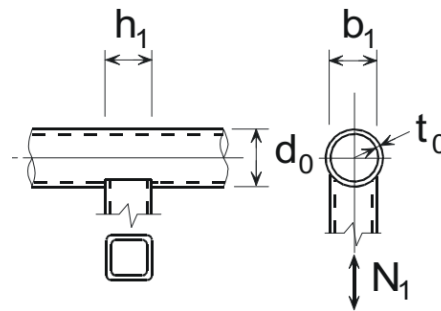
JUNTA SOLDADA EM T ENTRE DIAGONAL RHS E CORDA CHS (EC3-1-8 , QUADRO 7.4)
